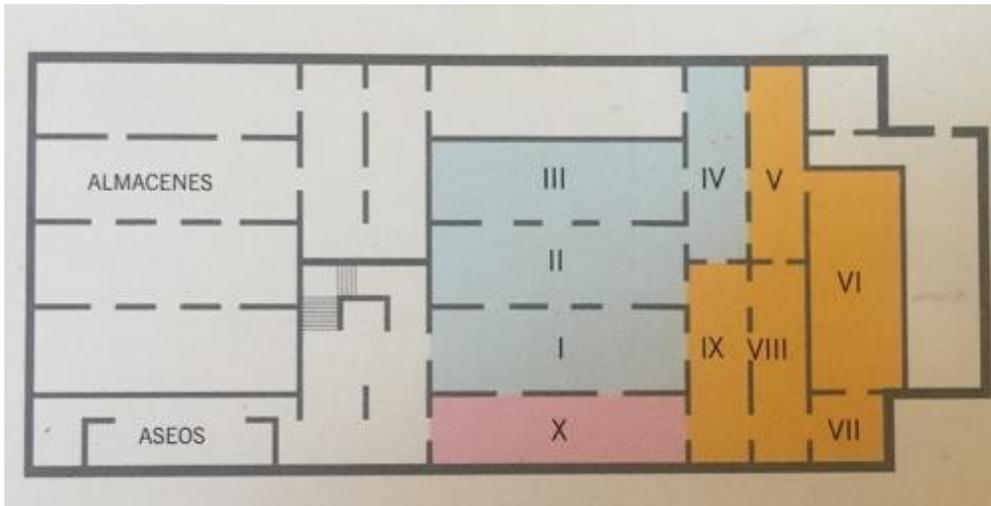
Plano de la planta baja, Museo Arqueológico Sevilla.
